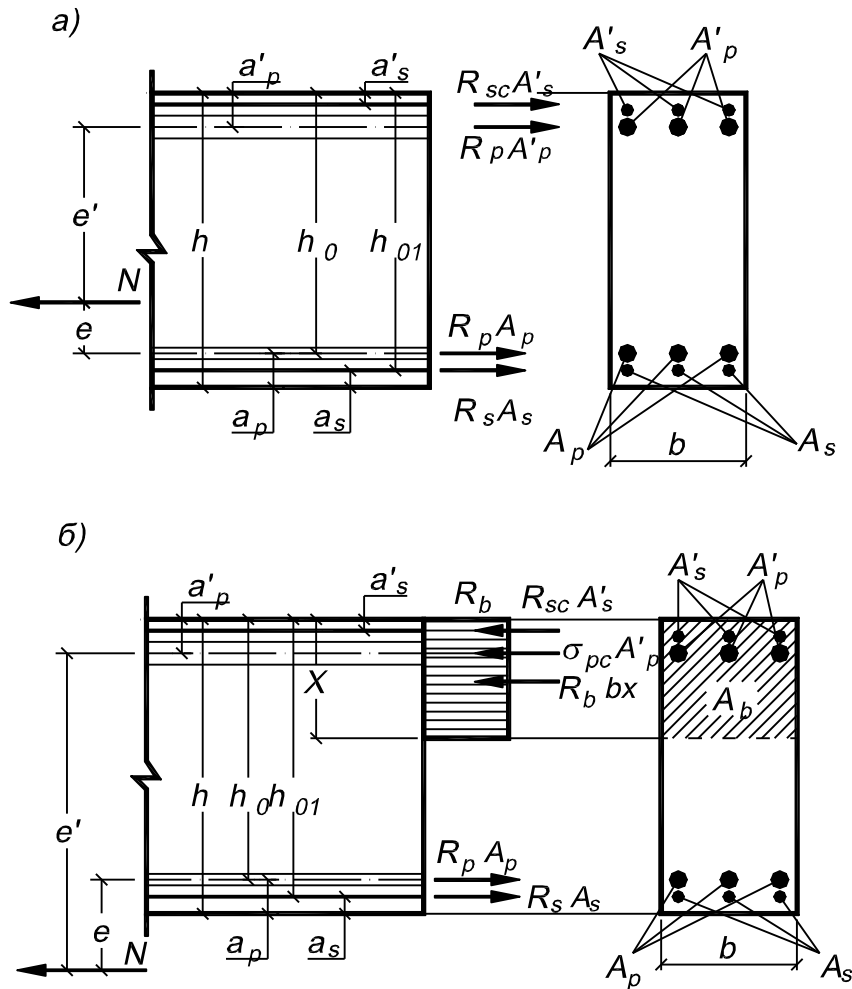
Схема зусиль і епюра напружень у перерізі, нормальному до поздовжньої осі позацентрово розтягнутого залізобетонного елемента при розрахунку його міцності
